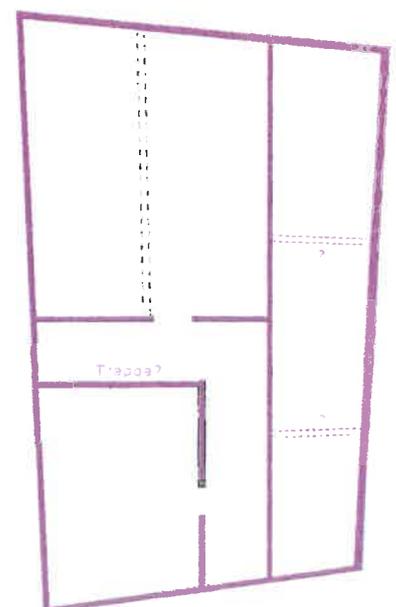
Rekonstruktion Grundriss 1690
